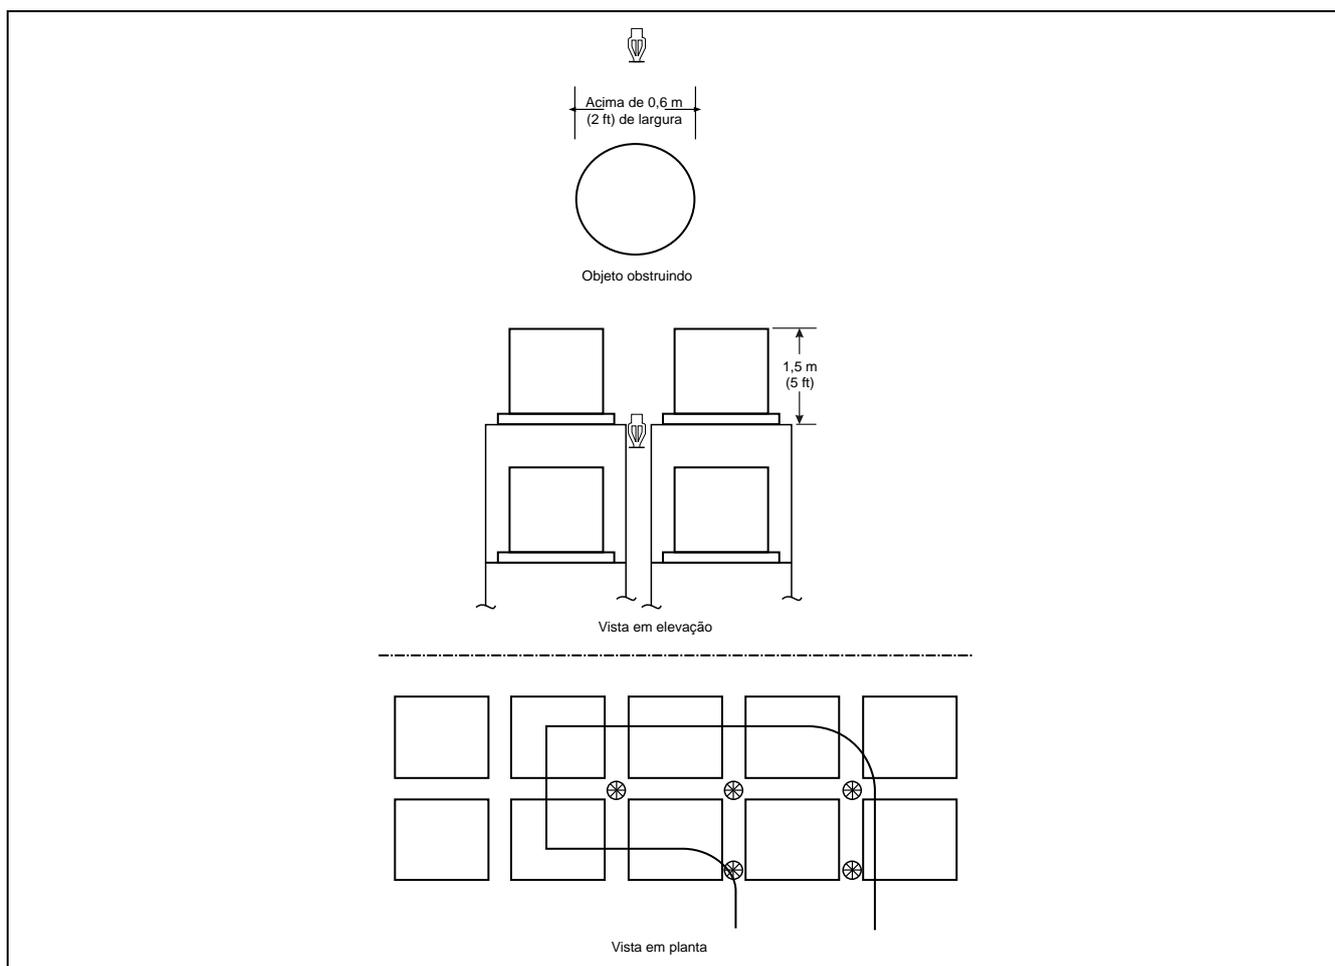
Sprinklers adicionais instalados dentro de porta-paletes para armazenagem para compensar obstruções ao núcleo interno do padrão de descarga de um sprinkler.
